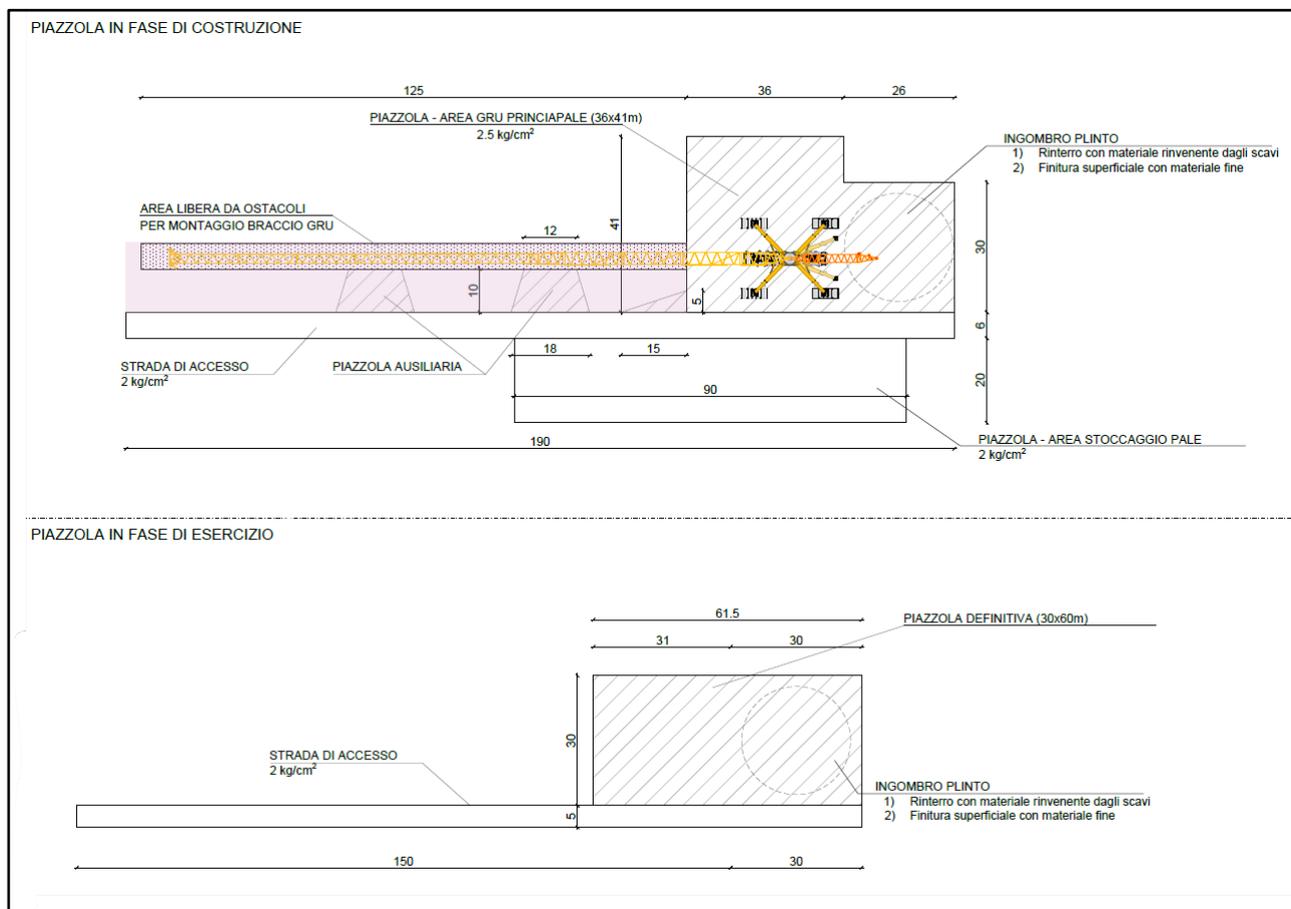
Planimetria piazzola tipo per la fase di installazione e fase di esercizio e manutenzione
